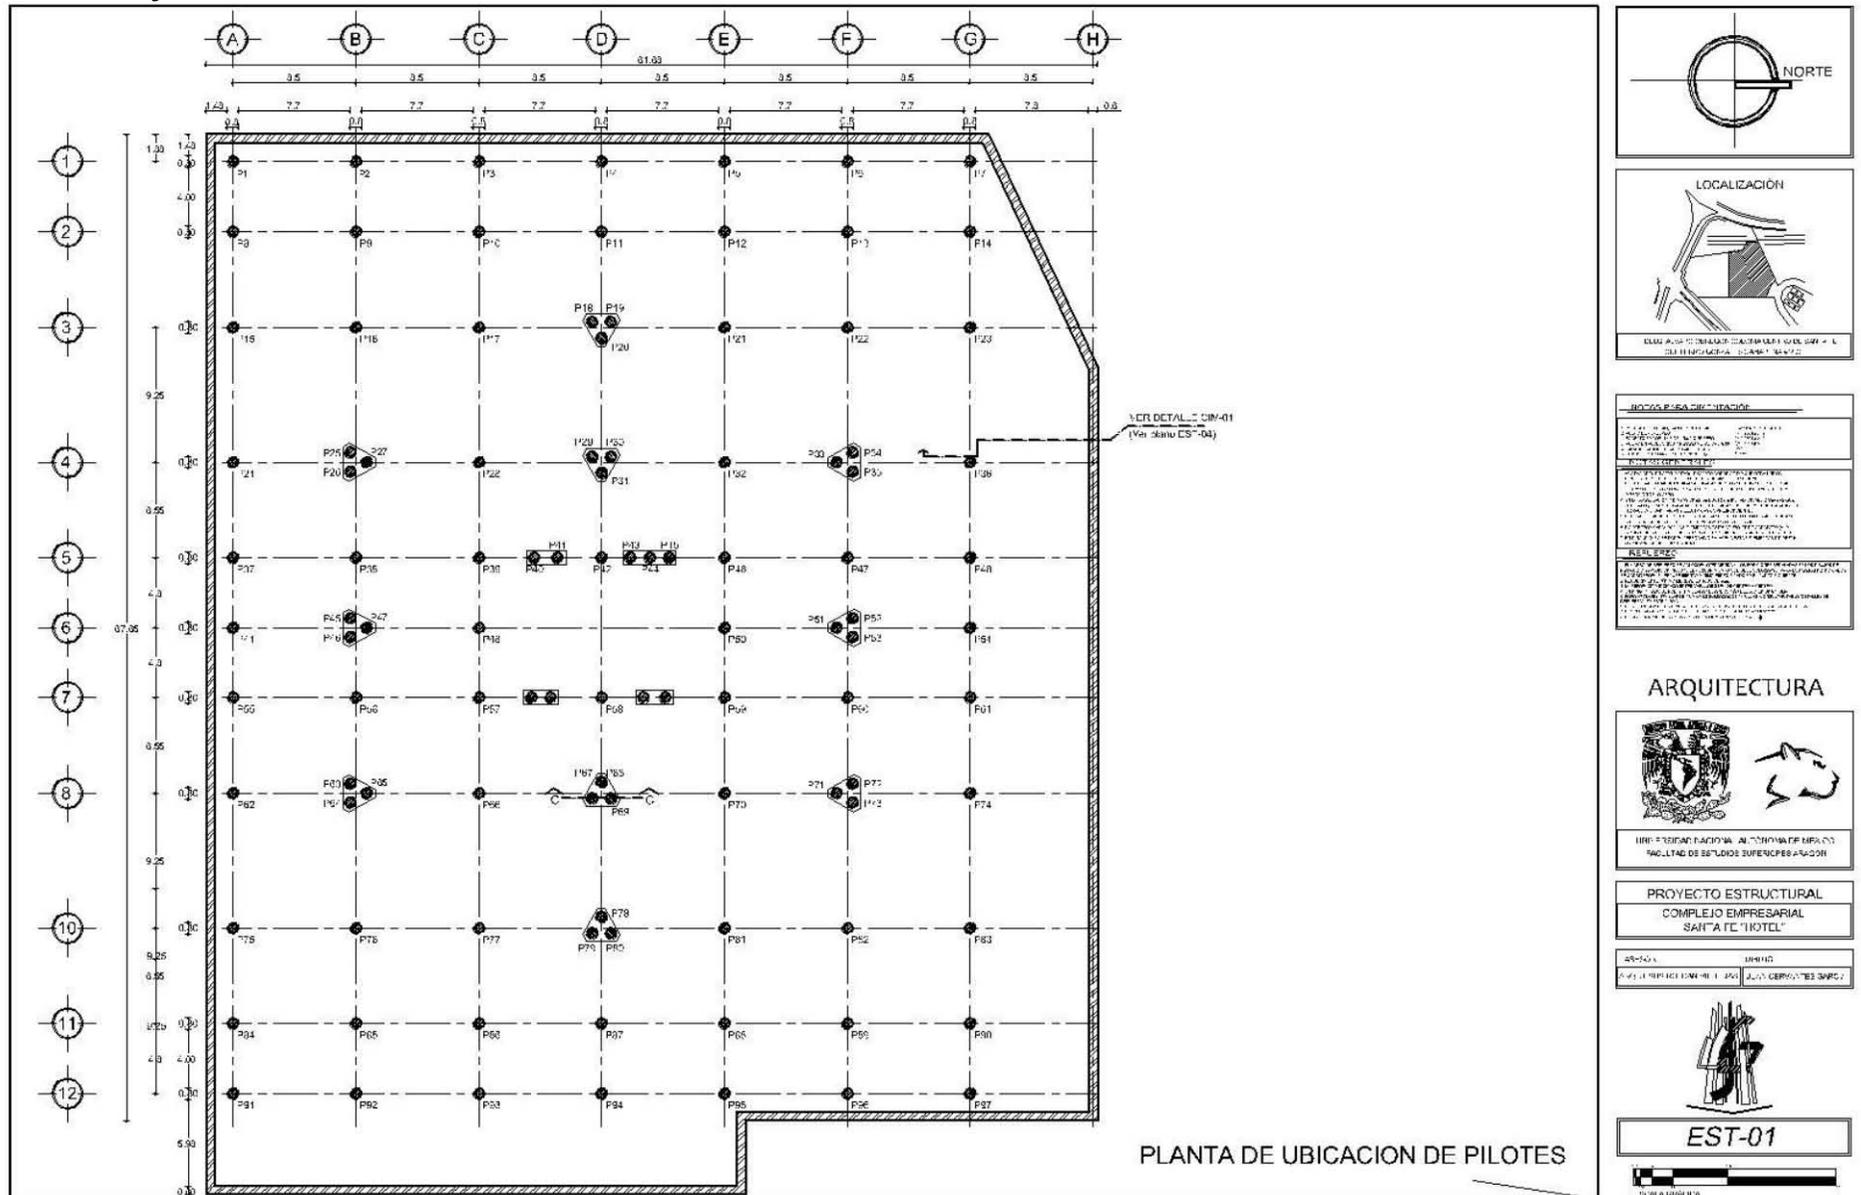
Plano Est-01; Ubicación de pilotes. Edición propia.
